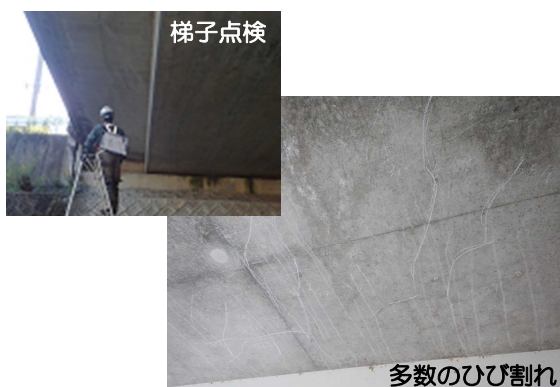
令和2年_ ひび割れ状況（梯子点検）
